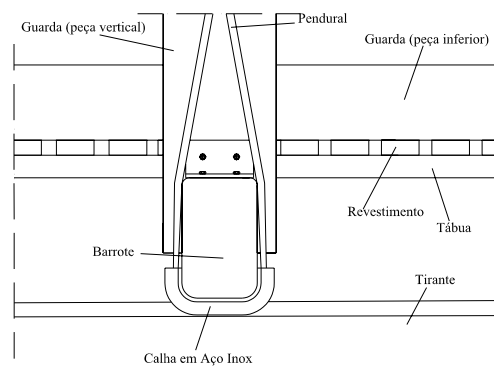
Pormenor da zona de passagem dos tirantes sob o pavimento (alçado).
